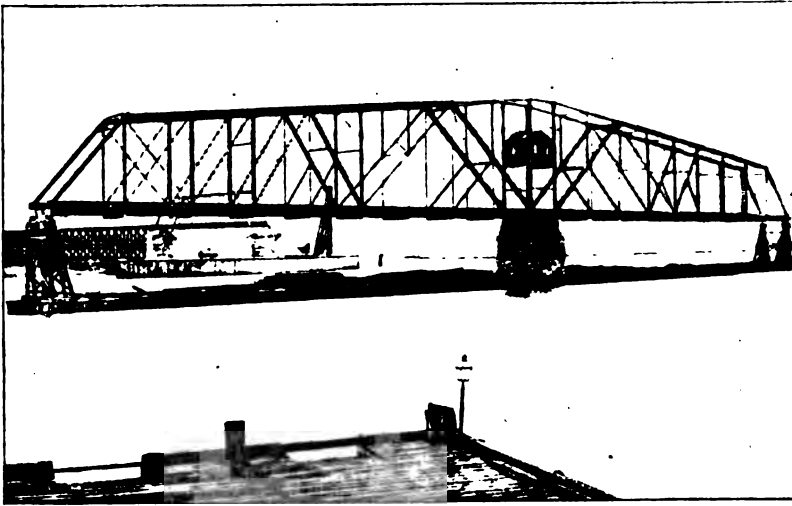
Travée tournante de 152^m,40 du Pont d'Arthur Kill, ouverte.
